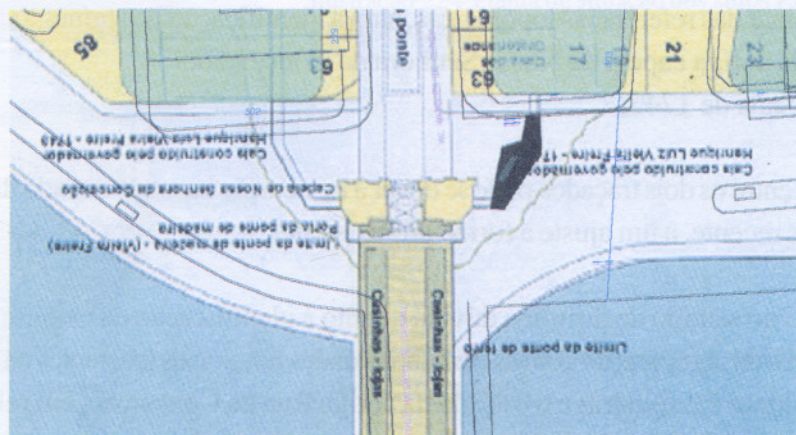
Sobreposição da planta atual, considerando-se a estrutura localizada como parte da fundação da capela.
